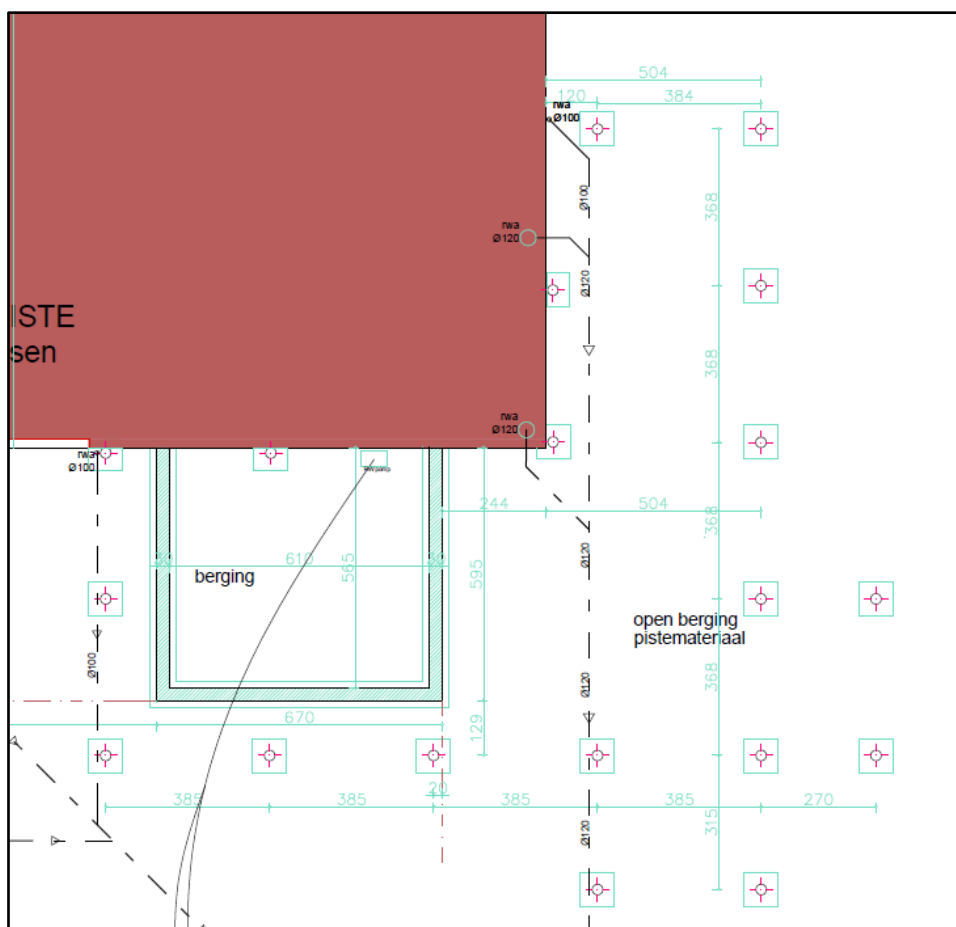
Funderingsplan paardenstal, opfokstal en overdekte mestopslag.⁸
